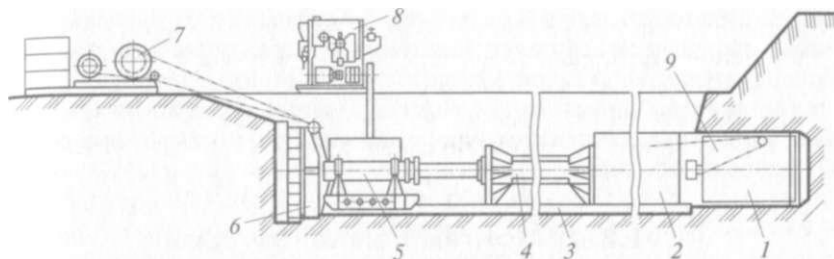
Схема установки для бестраншейной прокладки труб:
